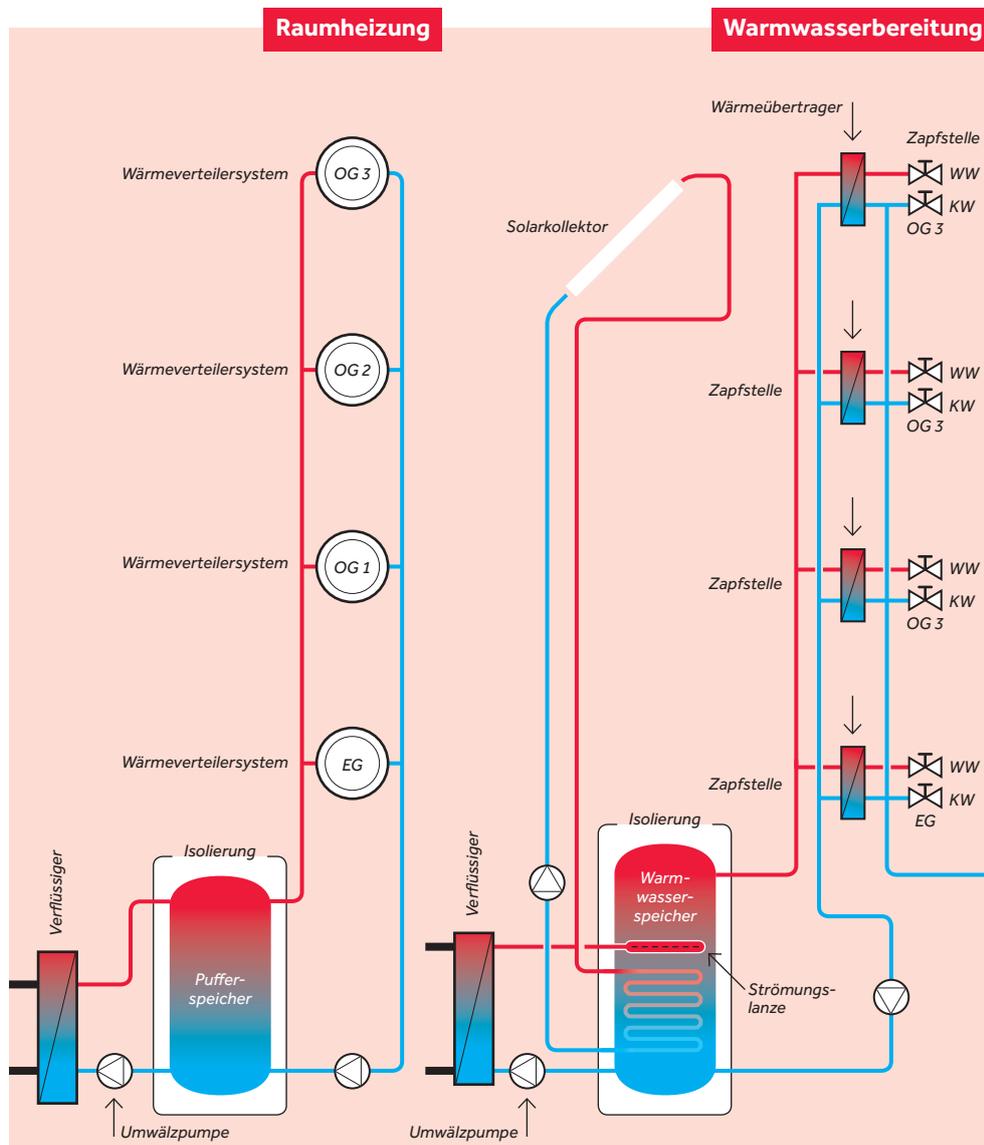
Prinzipdarstellung einer Heizungsanlage mit separaten Wärmepumpen zur Raumheizung und Warmwasserbereitung mit dezentralen Frischwasserstationen und Einbindung einer solarthermischen Anlage Quelle: AIT 2013
